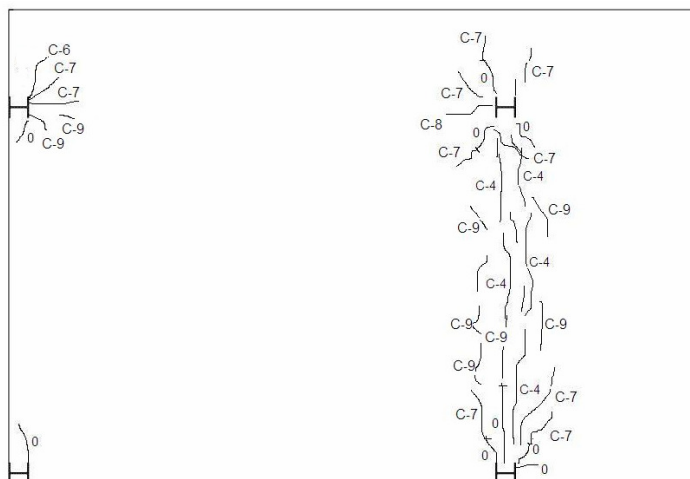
Esquema da formação de fissuras da laje - 1ª etapa de carregamento concentrado
